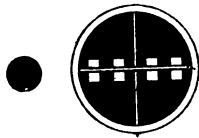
et 175. — Sections comparées des Câbles des Ponts de Brooklyn et sur l'Hudson.
